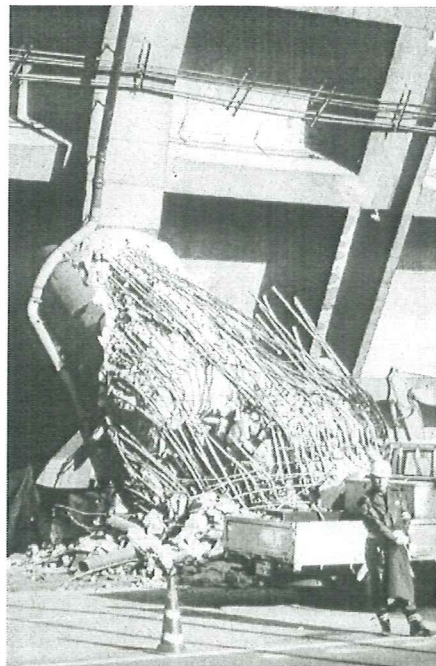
Una pila de hormigón armado en sección circular volvo debido a la falla en la zona de empalmes, Higashi - Nada Ward, Kobe.
